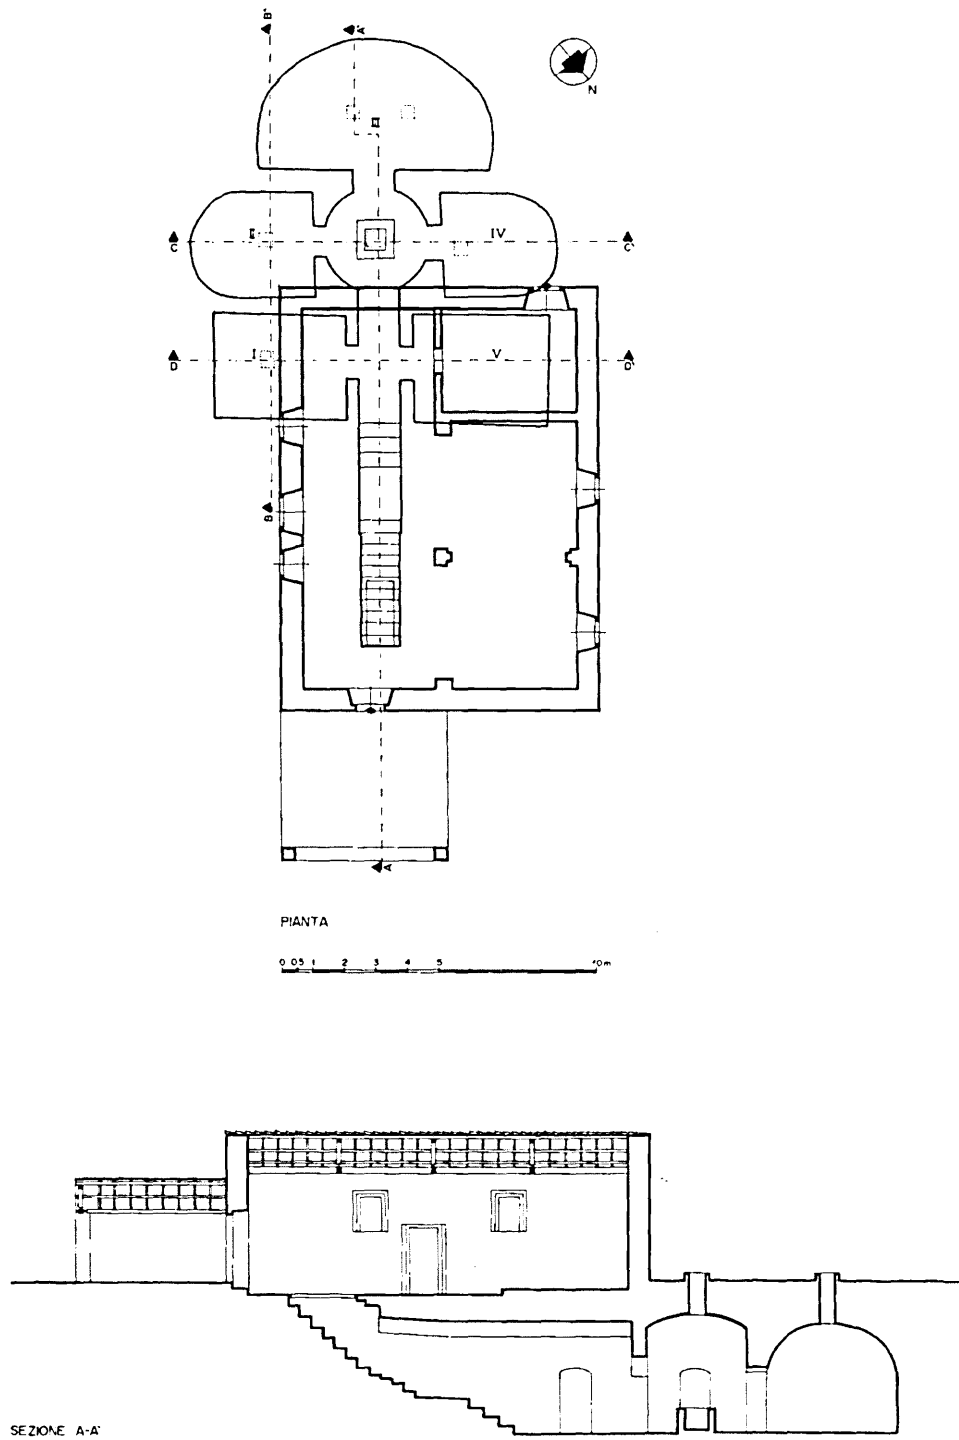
Cabras. San Salvatore: planimetria e sezione longitudinale dell'ipogeo (da DONATI, ZUCCA 1992).
